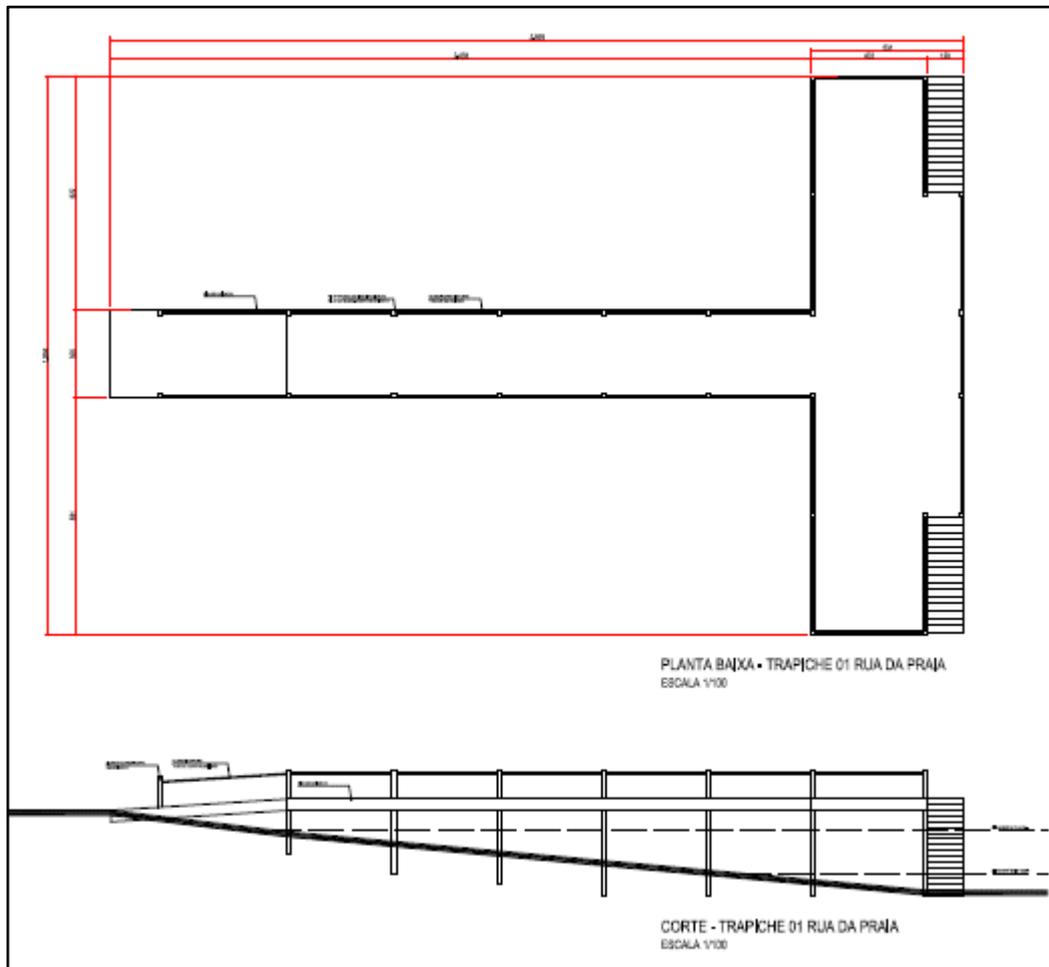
Trapiche de embarque para Guaraqueçaba – Planta baixa e corte
